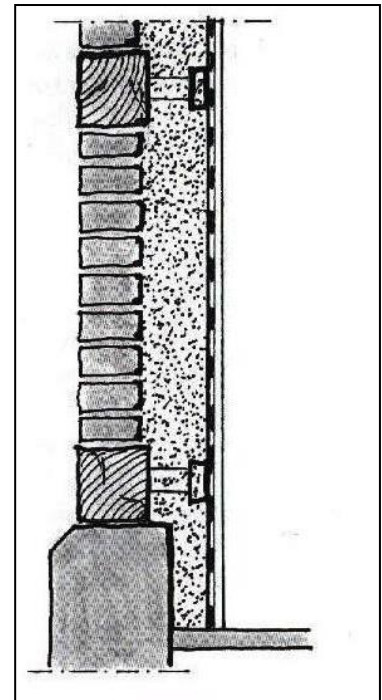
Restauració de la façana amb la incorporació d'argila i tancament amb barrera de vapor.
